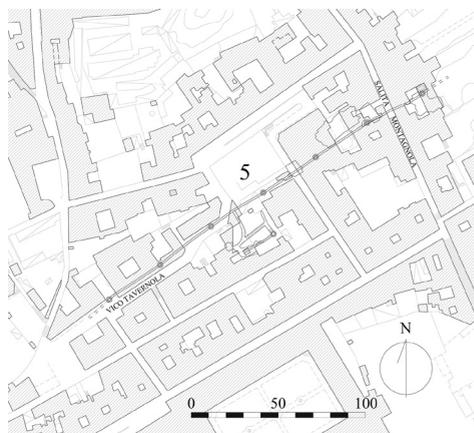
Planimetria della zona Miracoli (B in fig. 1): 5) speco in galleria tra salita Montagnola e vico Tavernola.
